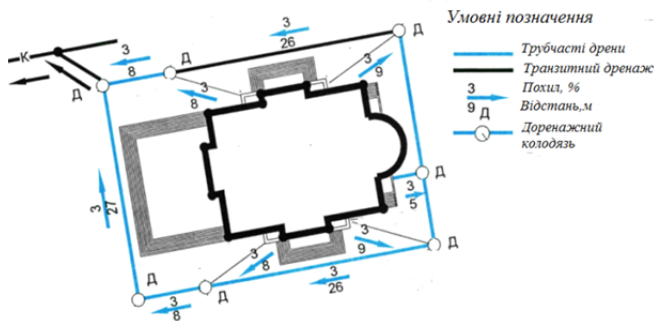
План кільцевого дренажу по контуру будівлі
